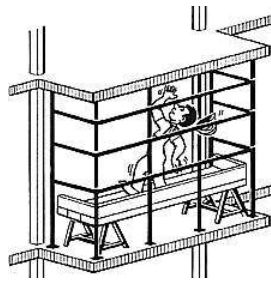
Cerramiento perimetral por medio de elementos verticales y horizontales
